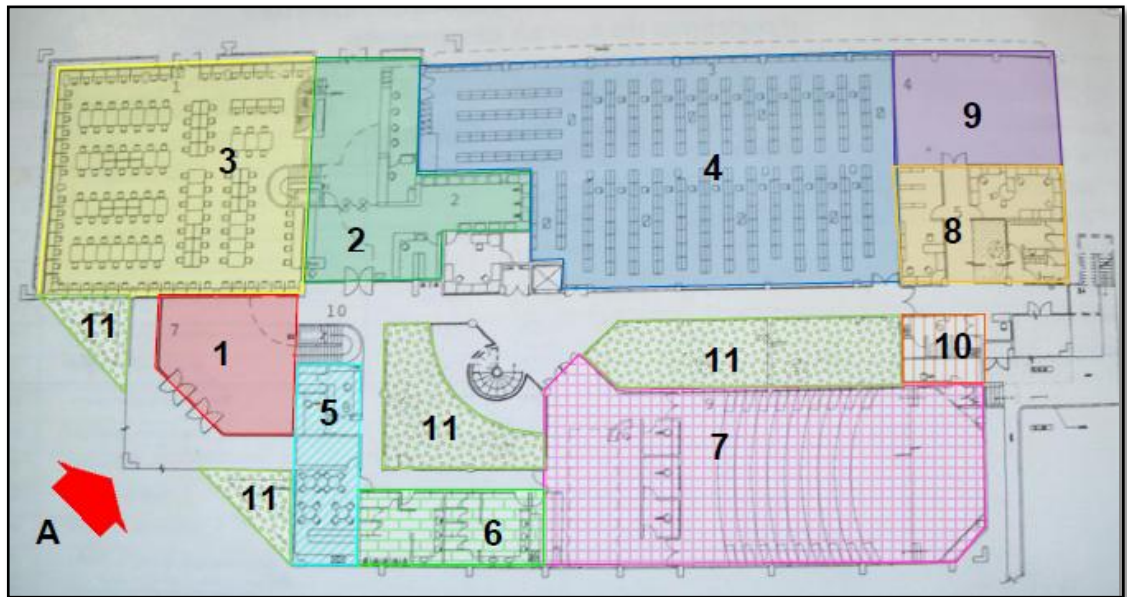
Planta Arquitectónica del Primer Nivel.
